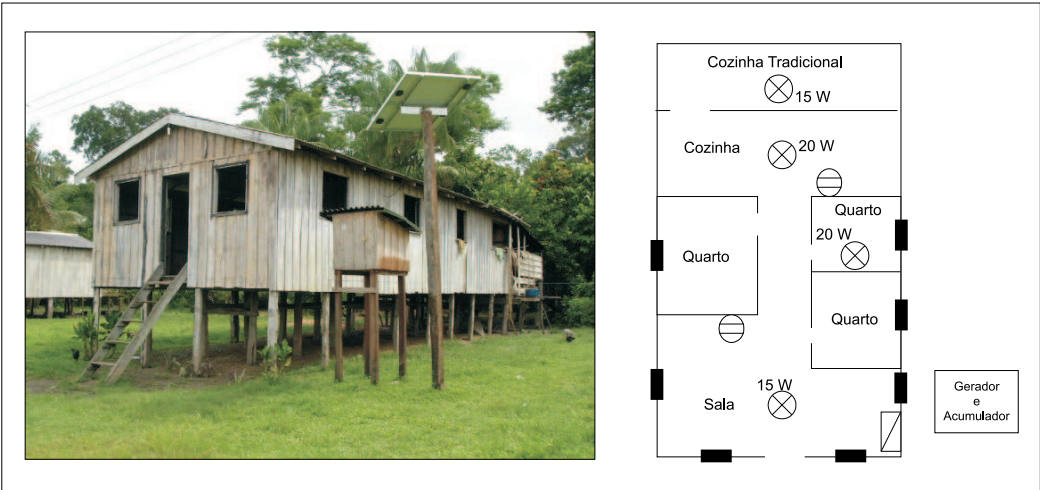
Vista externa do SFD5 e planta aproximada do domicílio.
